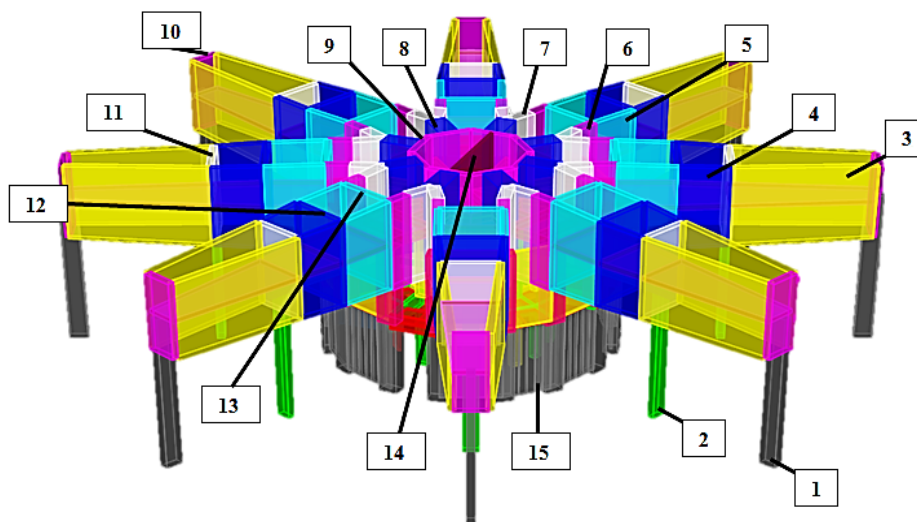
Elementos estruturais das vigas de cobertura modelados, bloco A; Fonte: os autores
